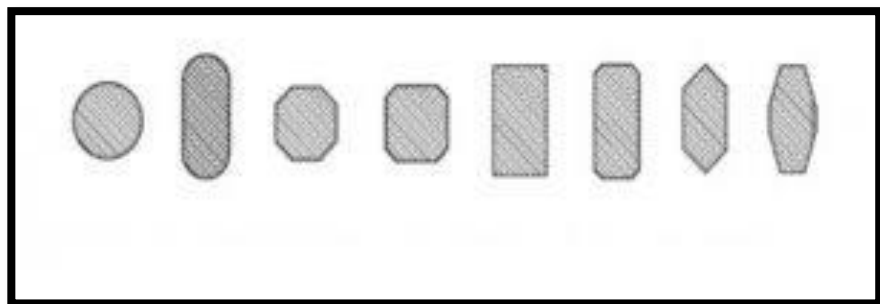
Tipos de sección transversal de columnas en puentes.
